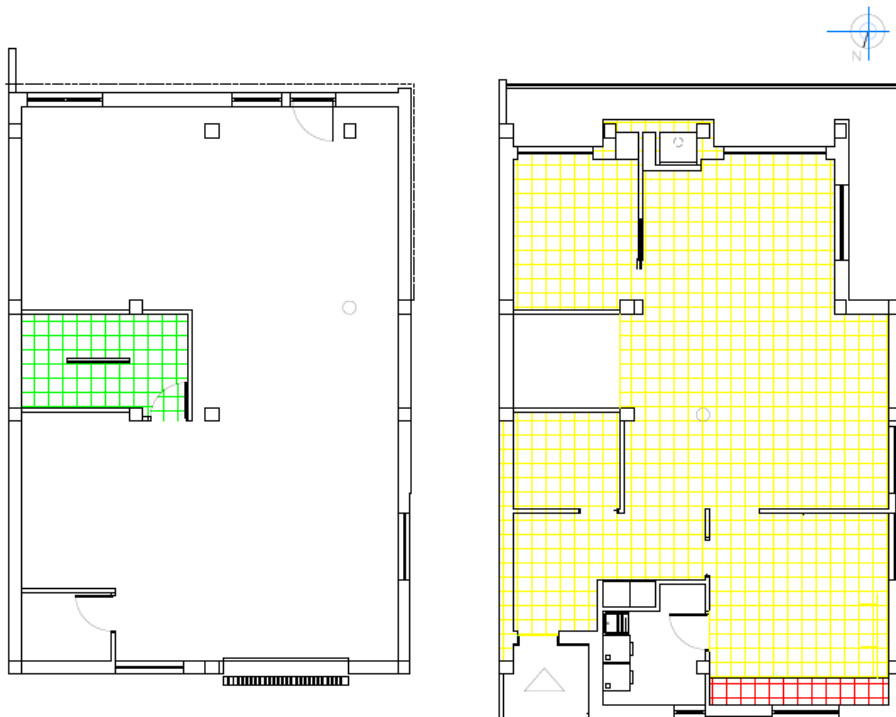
À esquerda o traçado dos pavimentos da envolvente na cave e à direita o traçado dos pavimentos da envolvente no rés-de-chão.
